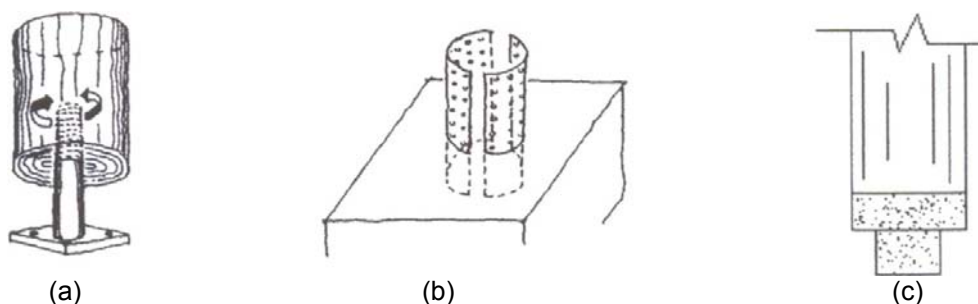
Possíveis soluções de conectores metálicos nas ligações da coluna de madeira roliça com bloco de fundação: (a) ligação articulada, com barra cilíndrica interna; (b) chapas metálicas perfuradas; (c) peça cilíndrica externa. Fonte: PARTEL (1999).
